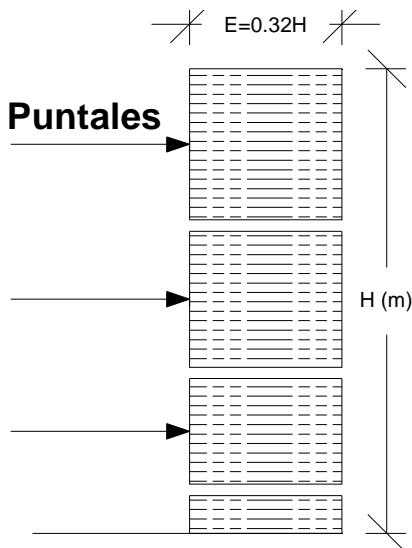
Empuje (ton/m<sup>2</sup>) para el cálculo del sistema de apuntalamiento o muros perimetrales
